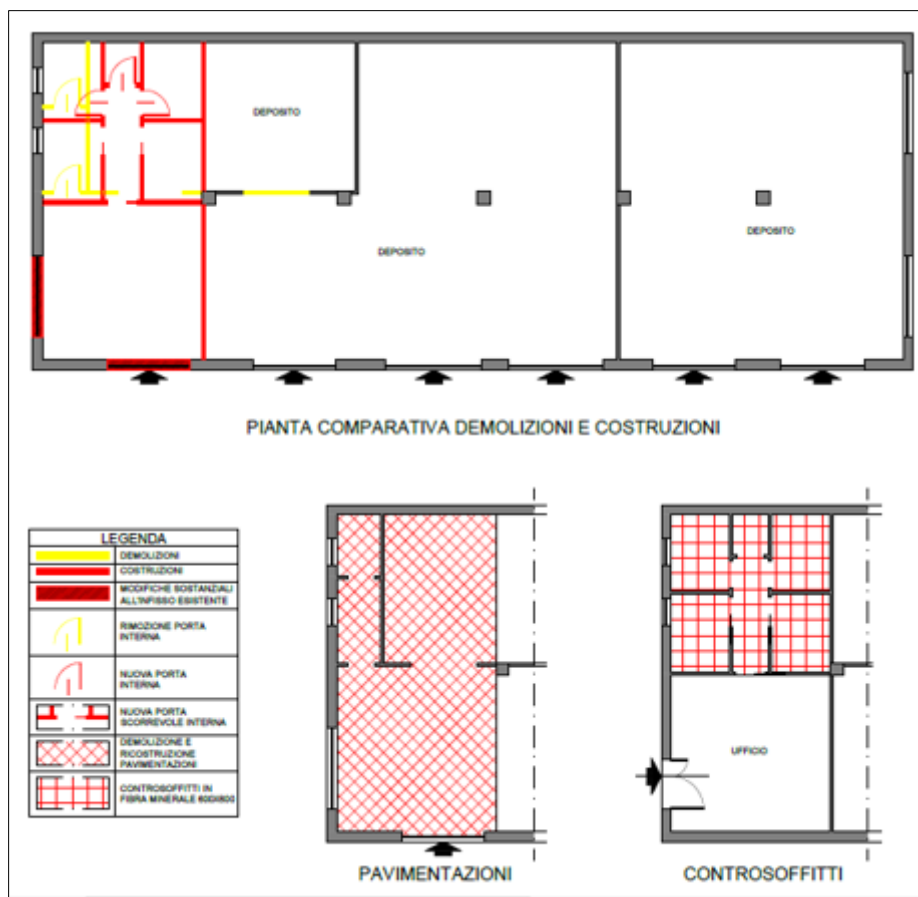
Pianta comparativa delle demolizioni e delle costruzioni previste sul fabbricato esistente
